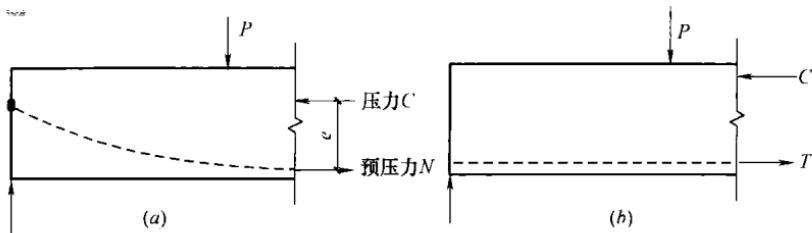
预应力混凝土梁与钢筋混凝土梁的内部抵抗力矩
